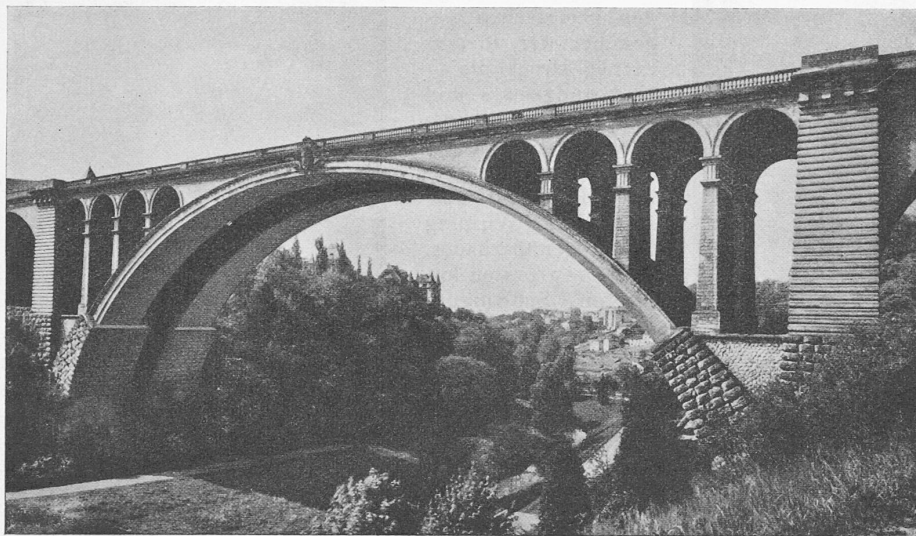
Adolph-Brücke über das Tal der Pétrusse in Luxemburg, 1899 bis 1903. Entwurf und Bauleitung: P. Séjourné. Bauausführung: Brücke M.M. Fougerolle, Eisenbeton M. Ed. Coignet.
